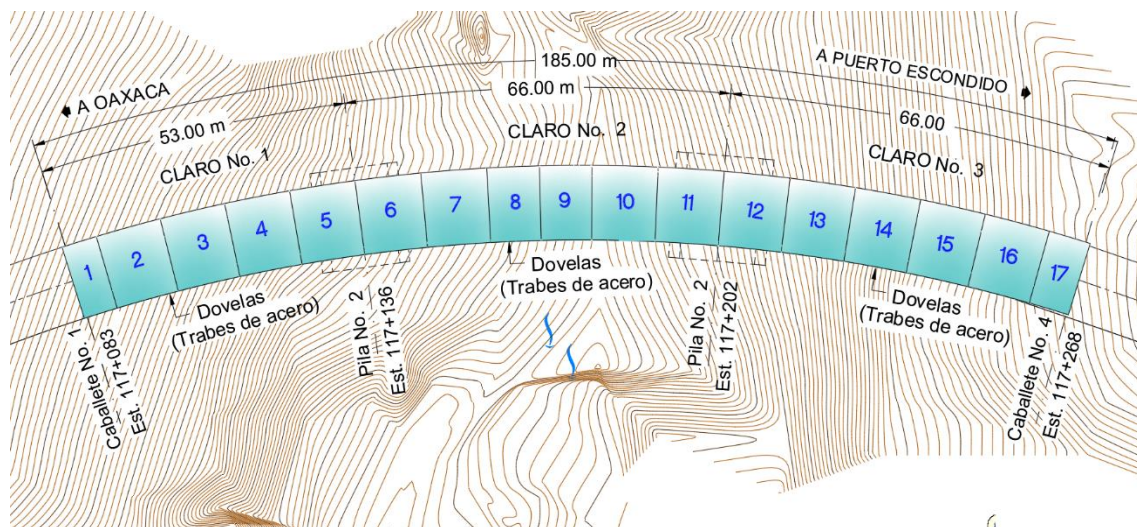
Planta esquemática del Viaducto 117+174. Fuente: Elaboración propia
